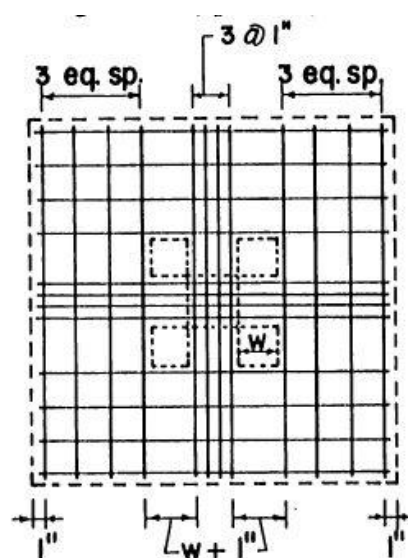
Disposição da armadura longitudinal e das aberturas utilizadas na série H [53]
